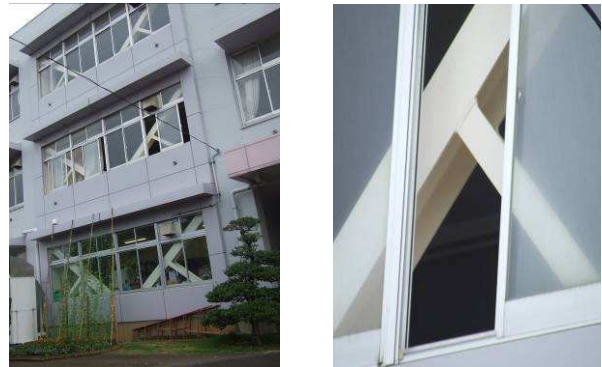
Bâtiment à ossature en béton armé renforcé par un contreventement métallique
